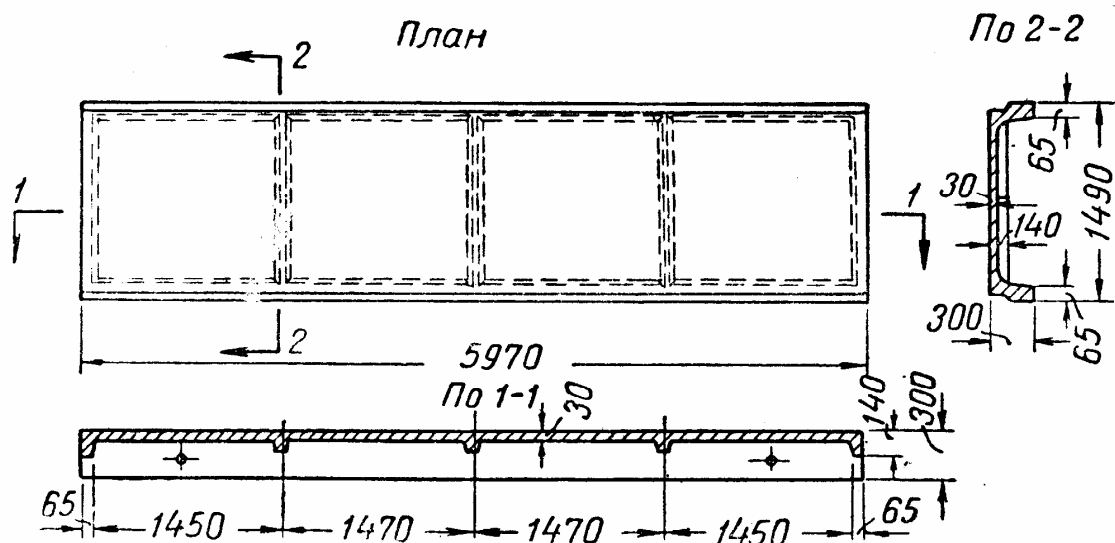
Конструкция железобетонной плиты размером 1,5×6 м
